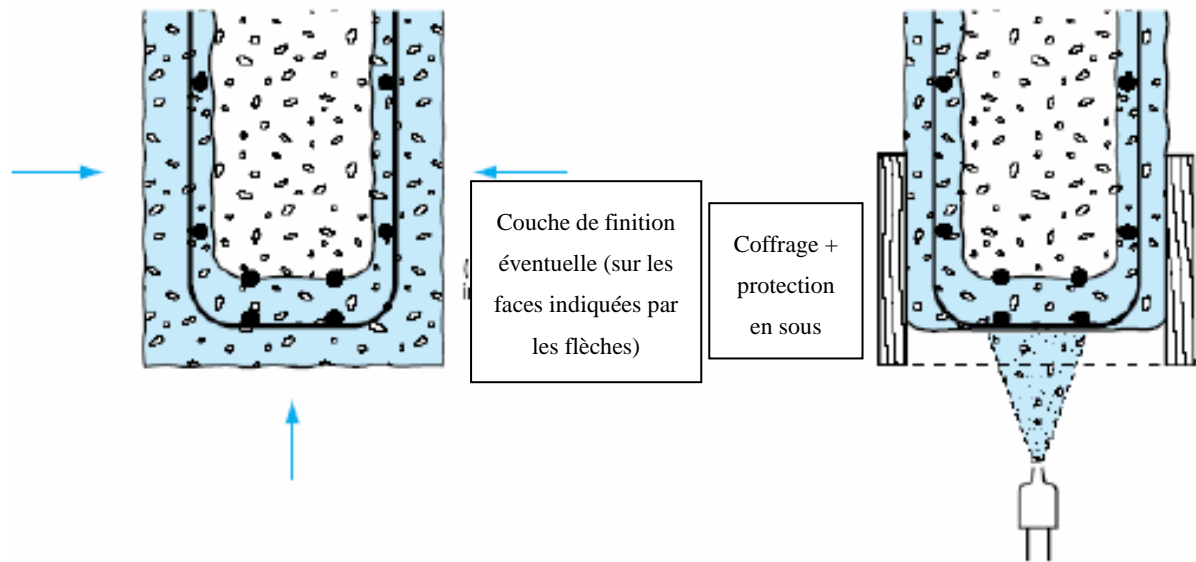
Réparation de poutre par béton projeté avec adjonction d'armatures complémentaires
